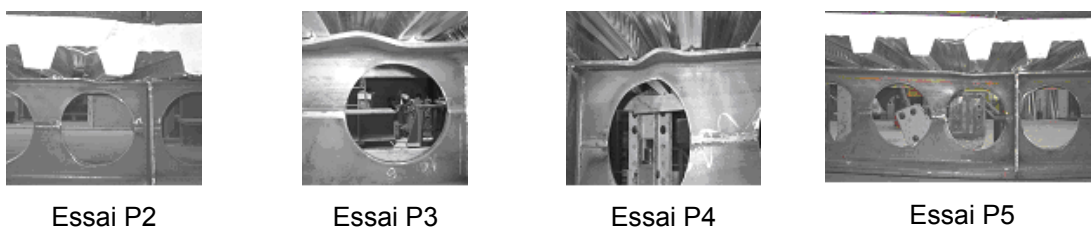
Modes de ruine pour des poutres cellulaires mixtes
